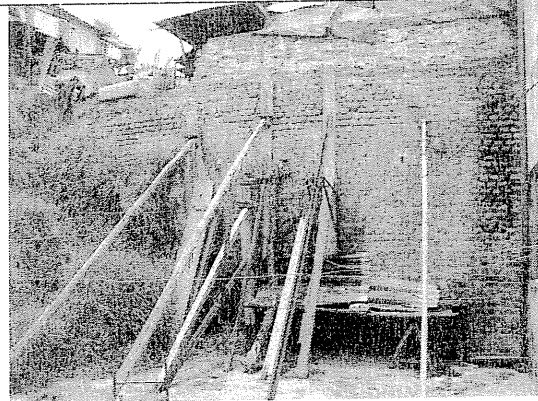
Elementos de soporte que evitan el volcamiento del muro.
